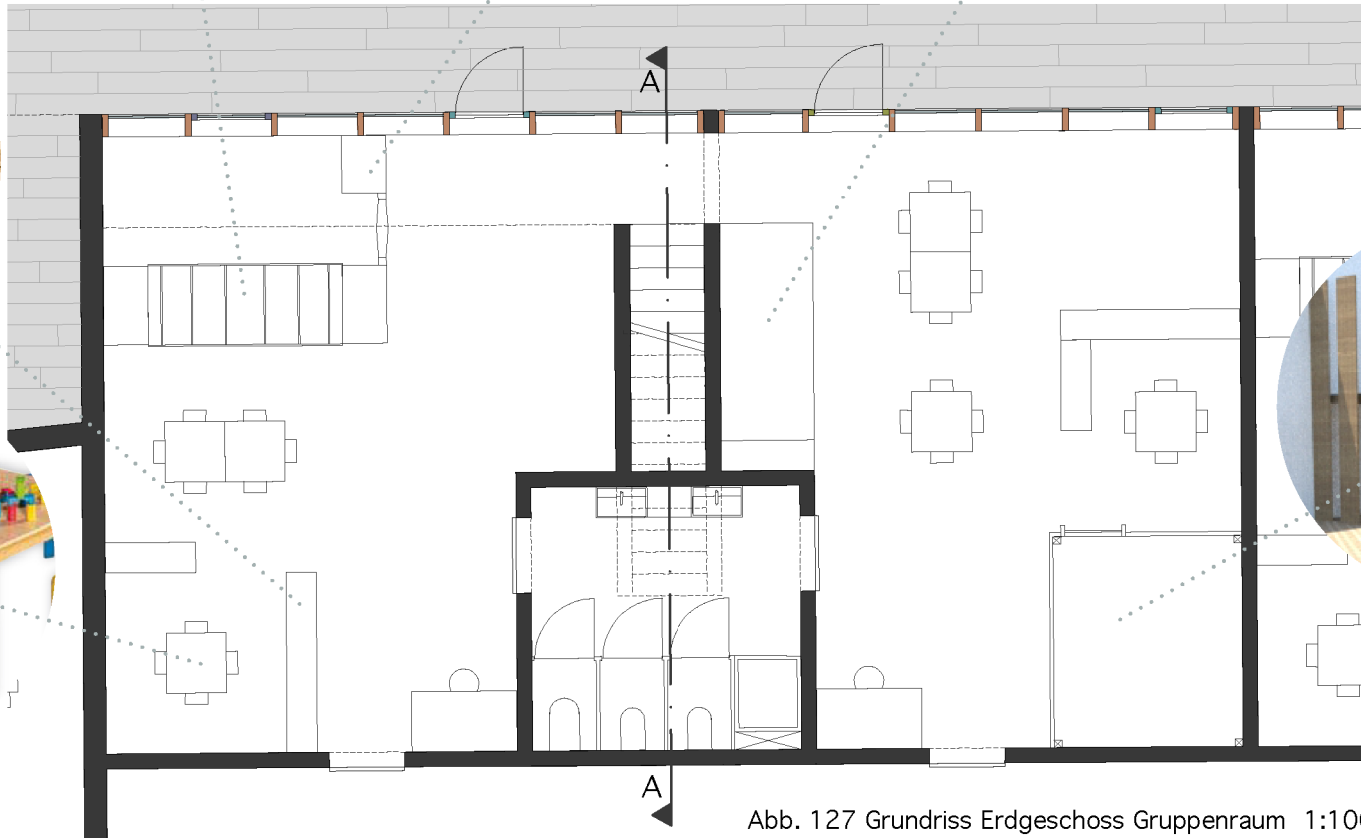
Grundriss Erdgeschoss Gruppenraum 1:100
